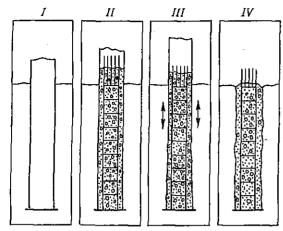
Рис. G. I. Стадии изготовления на месте набивной сваи GKN. I— временная обсадная труба погружается в грунт на заданную глубнну; II— устанавливается арматура и обсаженное пространство заполняется бетоном; III— обсадная труба в ходе извлечения подвергается колебательным движениям вверх и вниз; IV— свая в окончательном виде.
